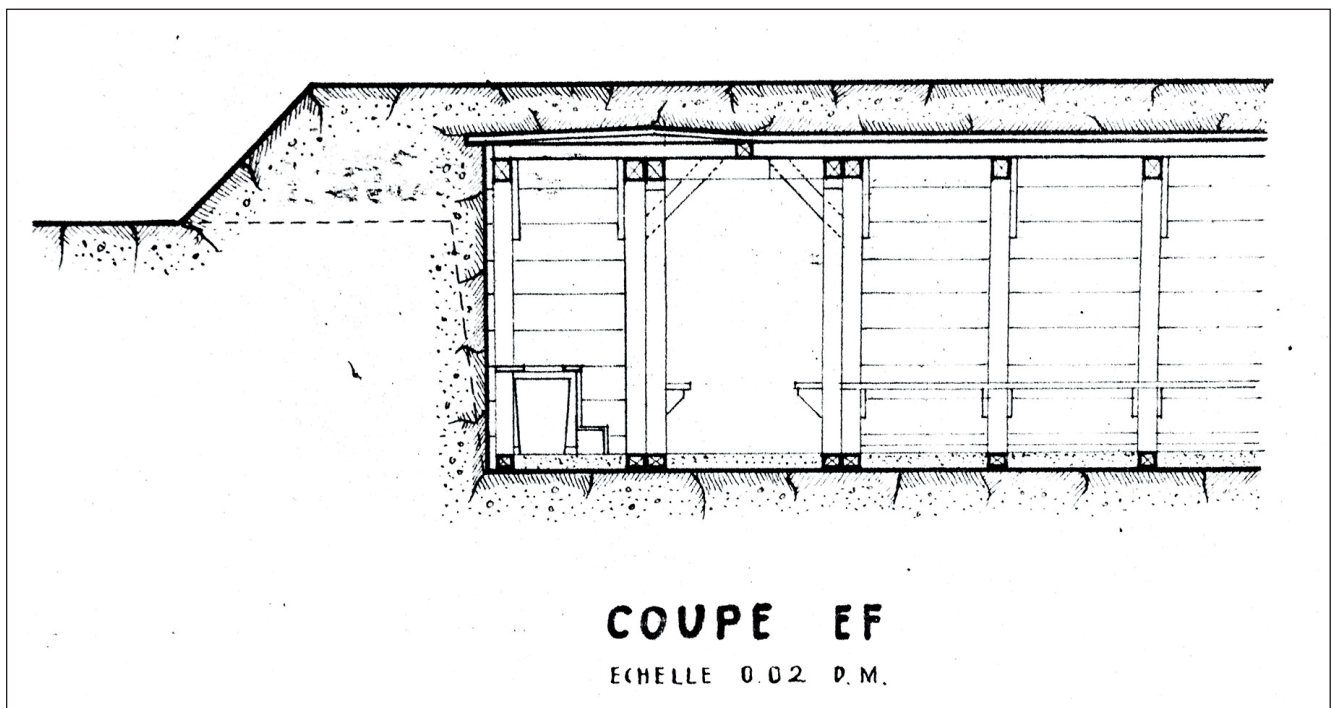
Coupe longitudinale d'une tranchée-abri à Gagny, 1942, Arch. mun. Gagny, boîte 1.
